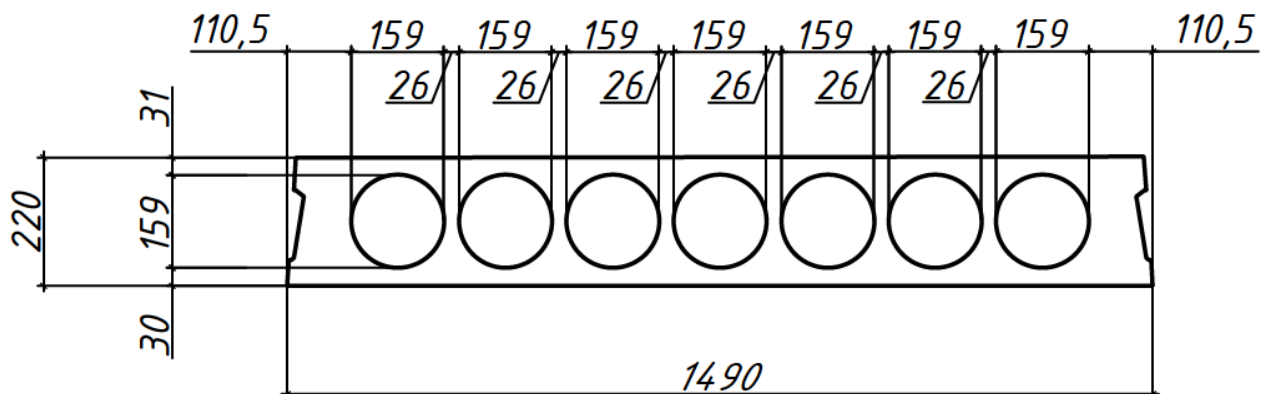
Поперечний переріз багатопустотної плити перекриття
